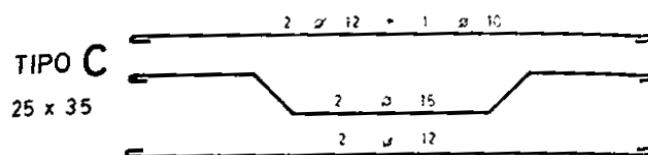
Plano despiece viga, ficha 91C.019, 1966
